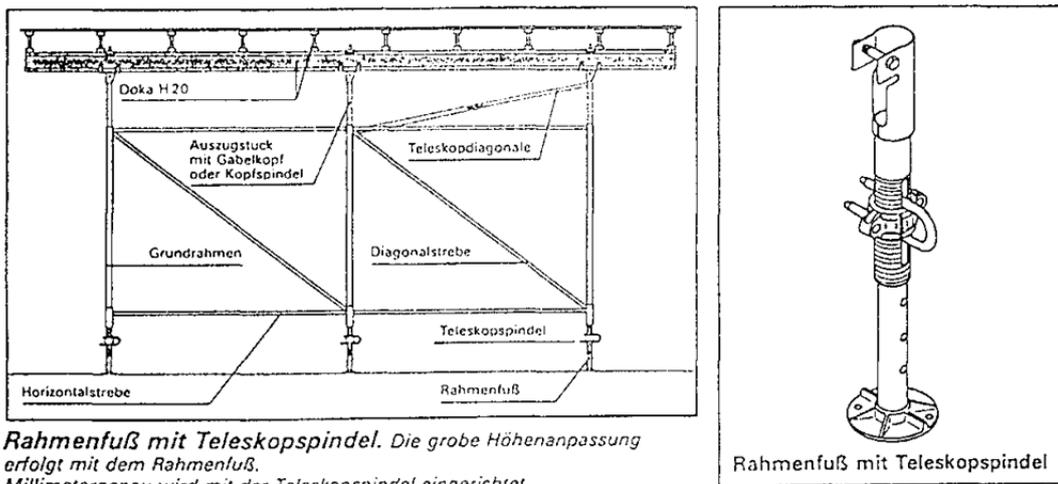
Deckentischschalungssystem – Elemente und Aufbau [4]
